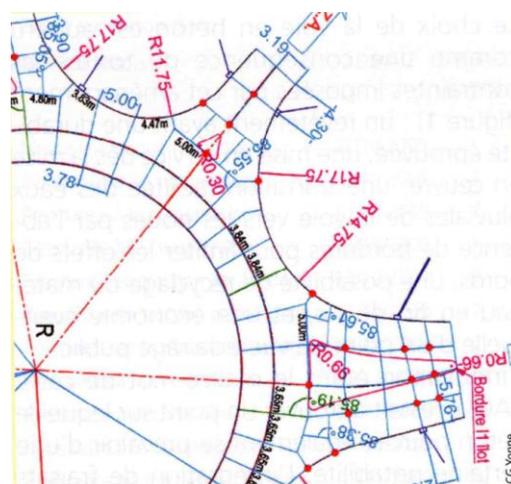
Exemple de calepinage de chaussée béton en dalles sur un giratoire
